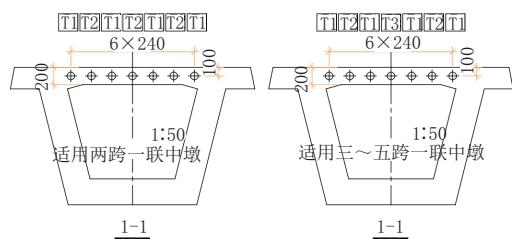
小箱梁张拉槽口优化设计断面图(单位:mm)
